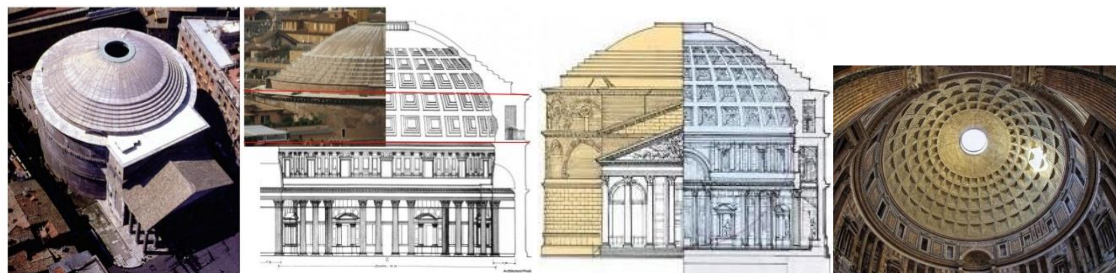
El Panteón, vista aérea de la cúpula, arranques interior y exterior, sección y óculo central, (fuente: es.wikiarquitectura.com)
